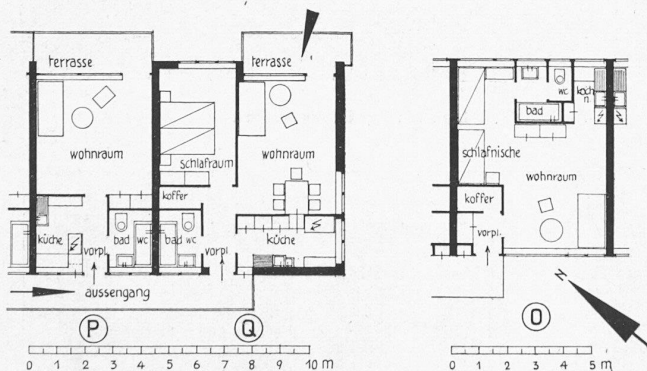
und 34. Grundrisse der Typen P, Q und O. — 1 : 250.
